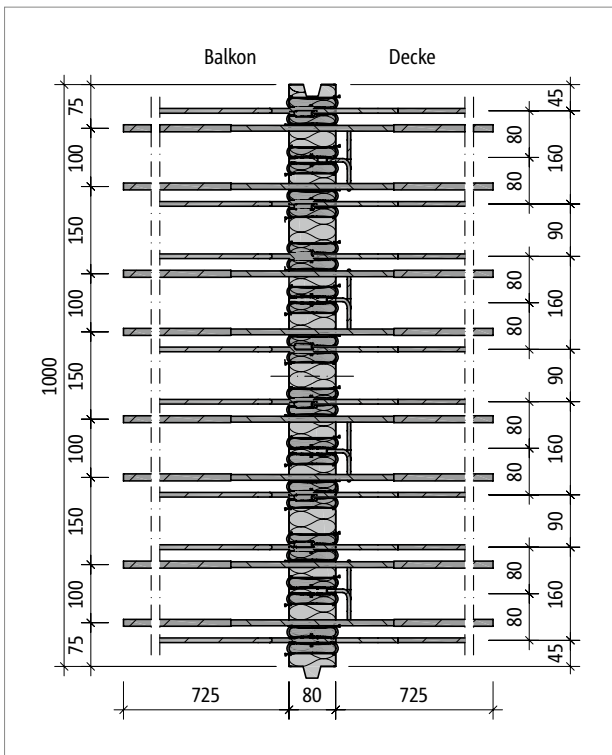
Schöck Isokorb® T Typ K-ID-M3-V2-R0-X80: Produktgrundriss
